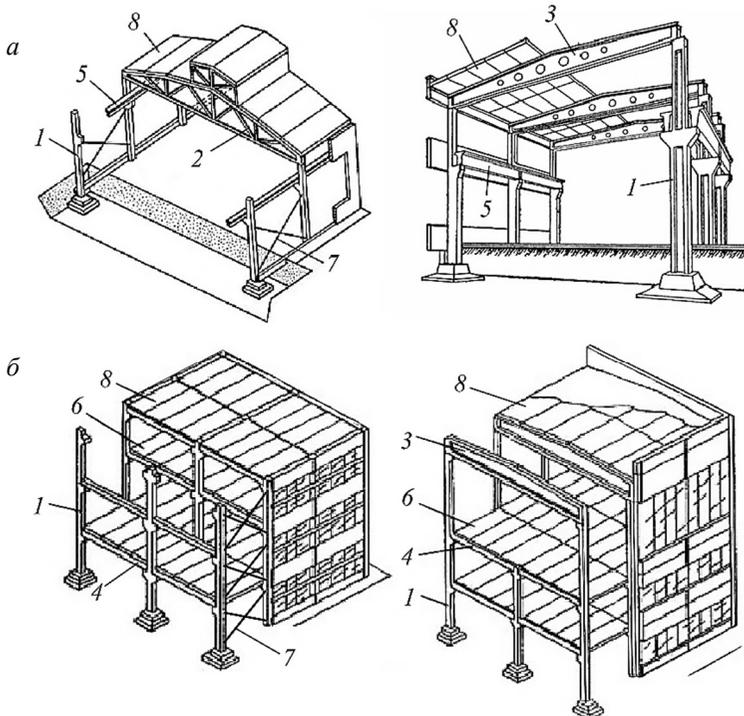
Каркас промышленного здания: *a* — одноэтажного; *б* — многоэтажного; 1 — колонна, 2 — стропильная ферма, 3 — стропильная балка, 4 — ригель, 5 — подкрановая балка, 6 — плита перекрытия, 7 — связи по колоннам; 8 — плита покрытия
